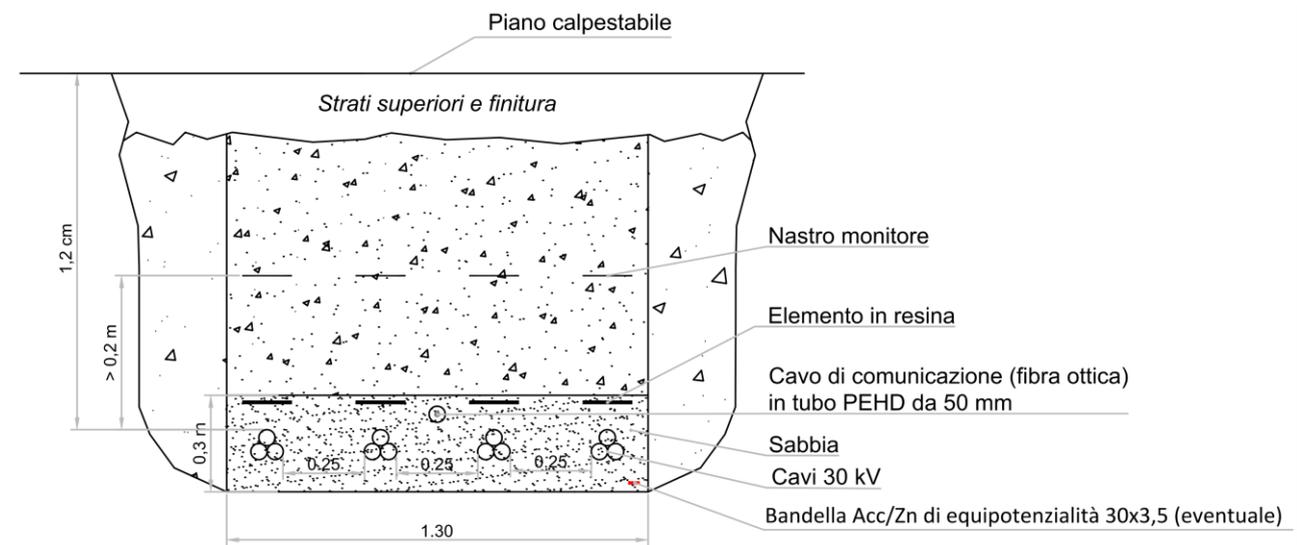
sezione tipo posa cavidotti 30 kV su campo/banchina
